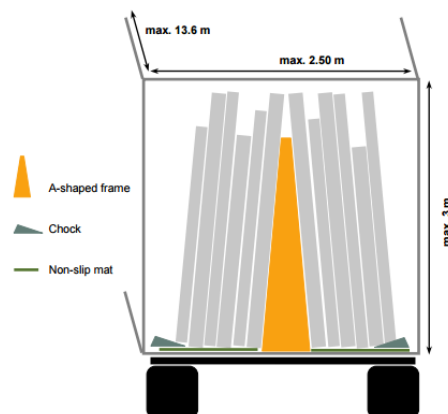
Dimensões de um caminhão com mega reboque (Stora Enso – Technical Folder, 2015).
